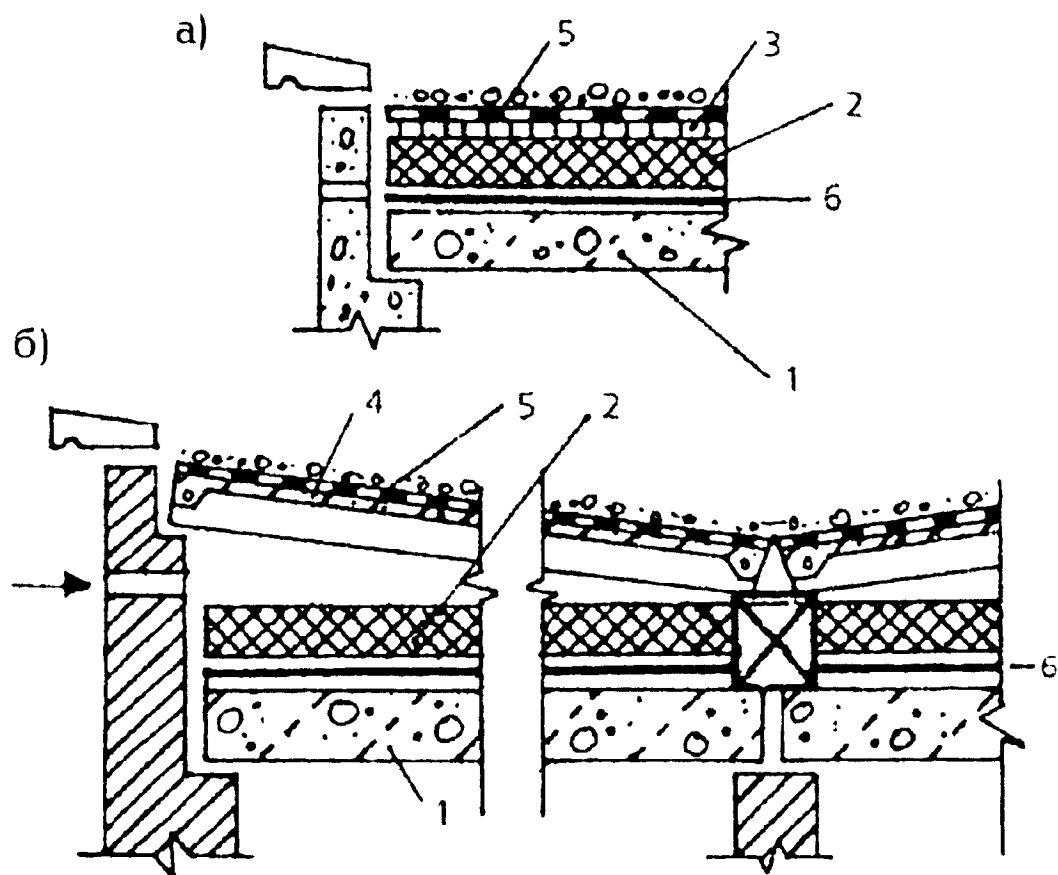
Совмещенные покрытия гражданских зданий: а - неventилируемое; б - ventилируемое: 1 - плита перекрытия; 2 - утеплитель; 3 - стяжка; 4 - кровельная панель; 5 - гидроизоляция; 6 - пароизоляция
